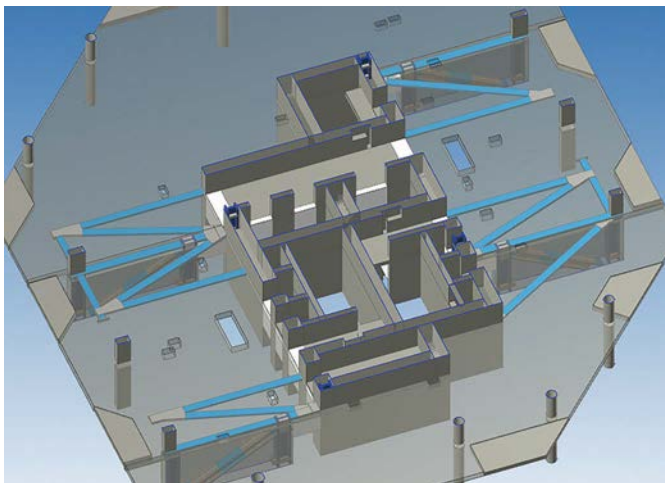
Stahlfachwerk der Decke Outriggergeschoss (Quelle: ATW FOUR)
